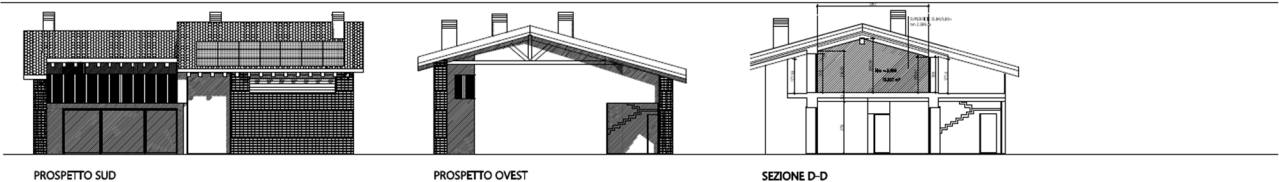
Estratto della tav.U di gennaio 2025 dell'arch. Sandro Garengo.
